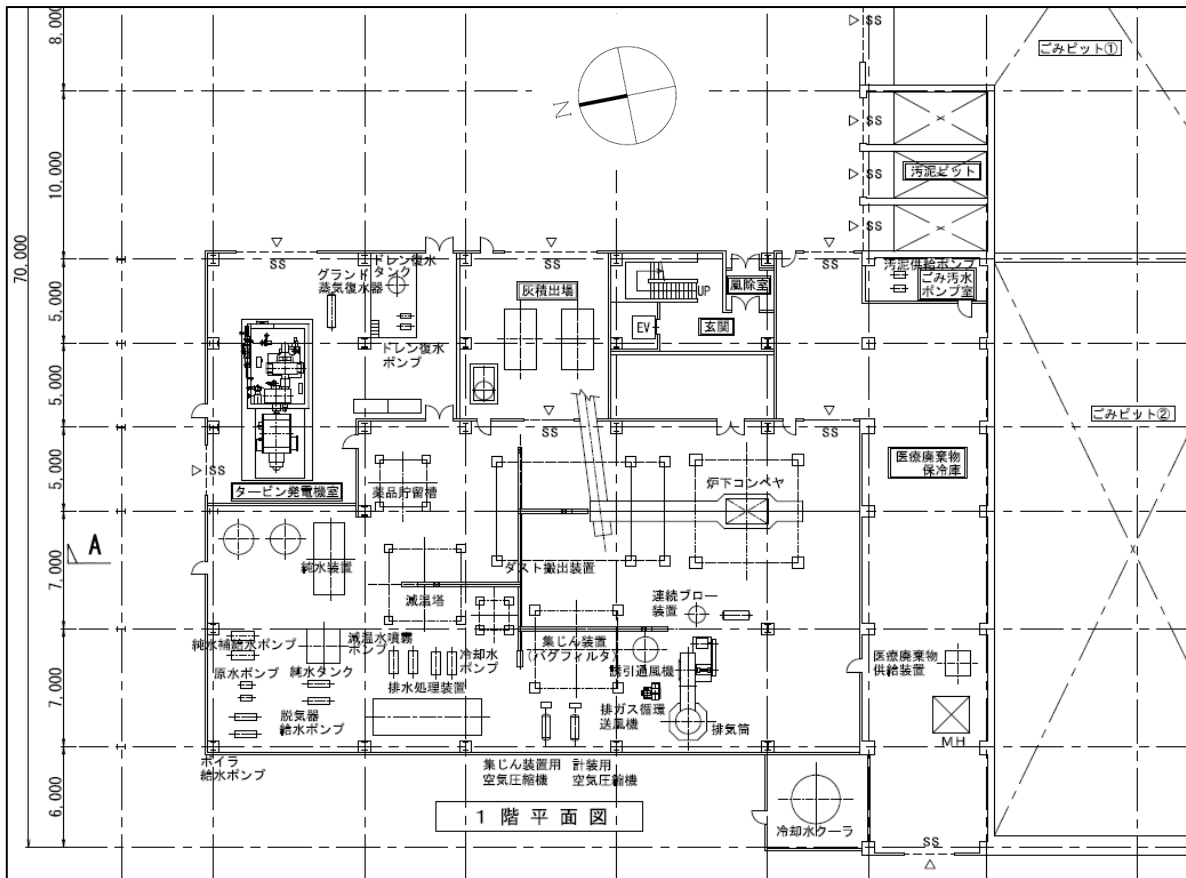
(1) 設備配置図 (焼却施設 1 階)
